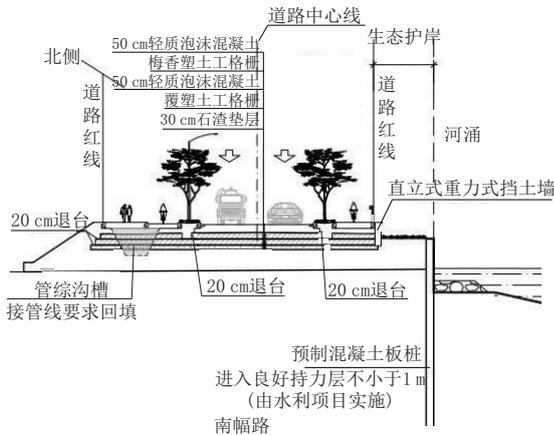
北幅路轻质泡沫混凝土路基处理布置断面图
